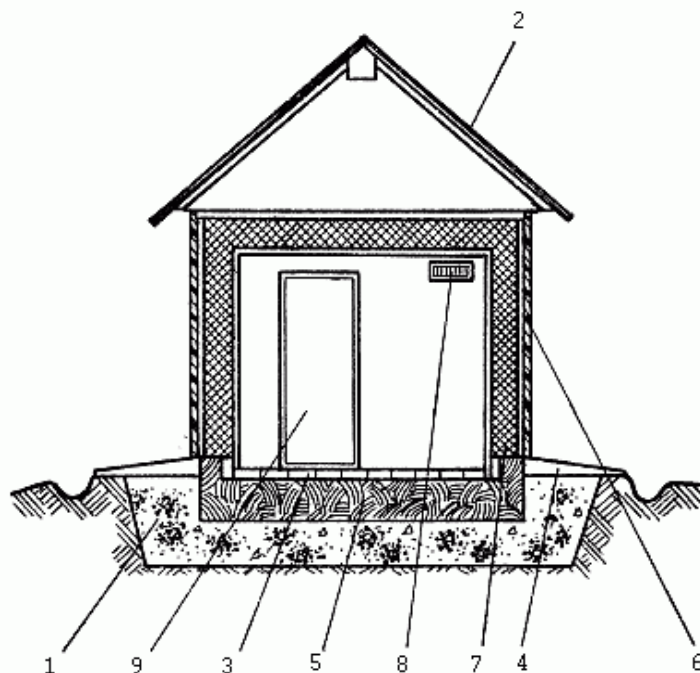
Мини-погреб наземной конструкции: 1 – песчано-щебеночная подготовка; 2 – двускатная кровля; 3 – кирпичный пол; 4 – отмостка; 5 – глиняный замок; 6 – гидроизоляция; 7 – утеплитель; 8 – окошко для вентиляции; 9 – дверь
